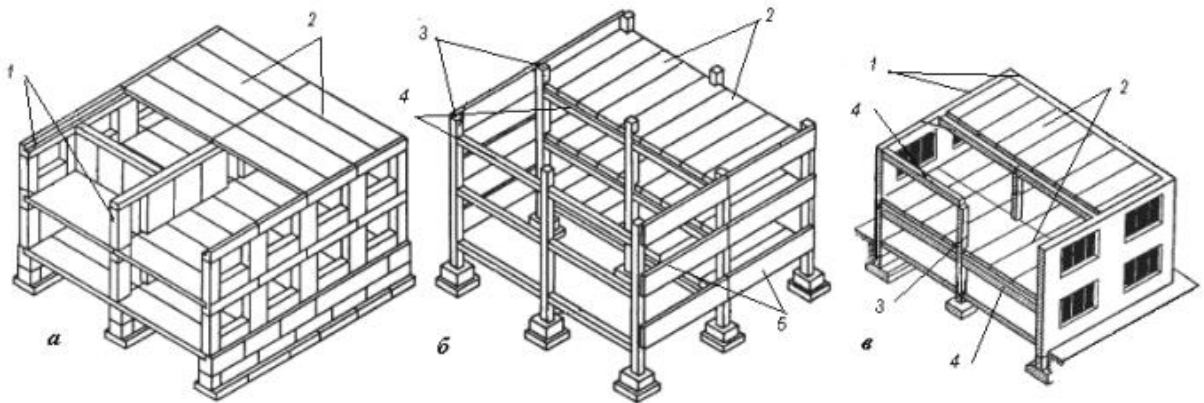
Конструктивні типи громадських будівель: а – безкаркасний; б – каркасний; в – з неповним каркасом. 1 – несучі стіни; 2 – міжповерхове перекриття; 3 – колони; 4 – ригель; 5 – ненесучі стіни
